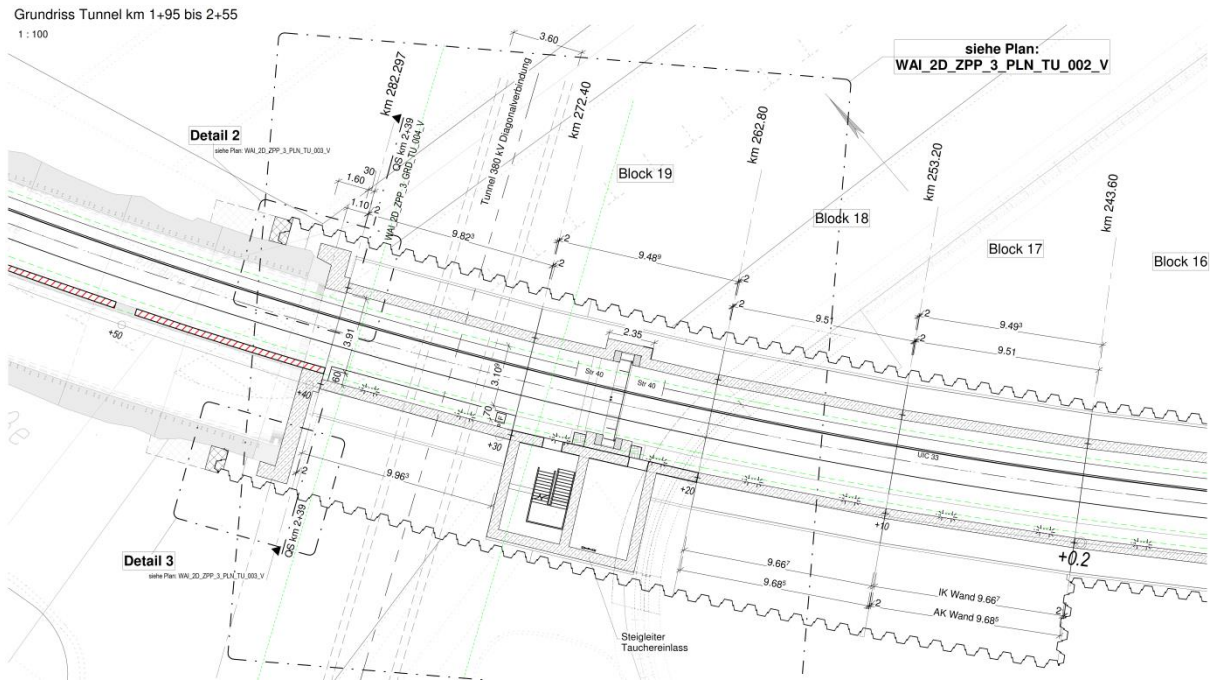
Grundriss Ersatzneubau km 1+95 bis 2+55
